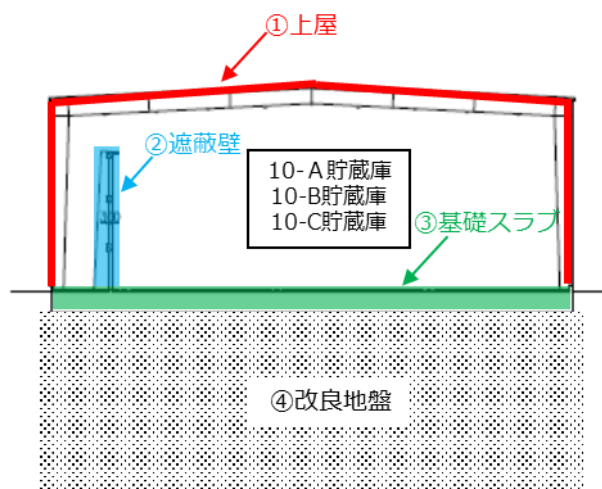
固体廃棄物貯蔵庫第10棟建屋断面図
